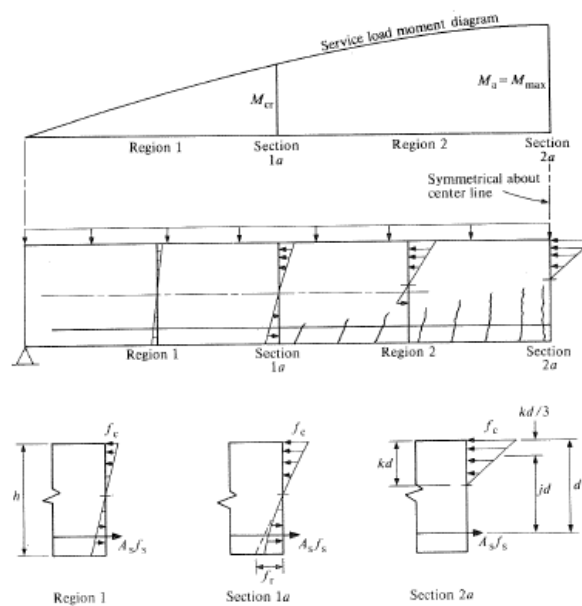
Diversas secciones en una viga de hormigón armado fisurada. [9]
